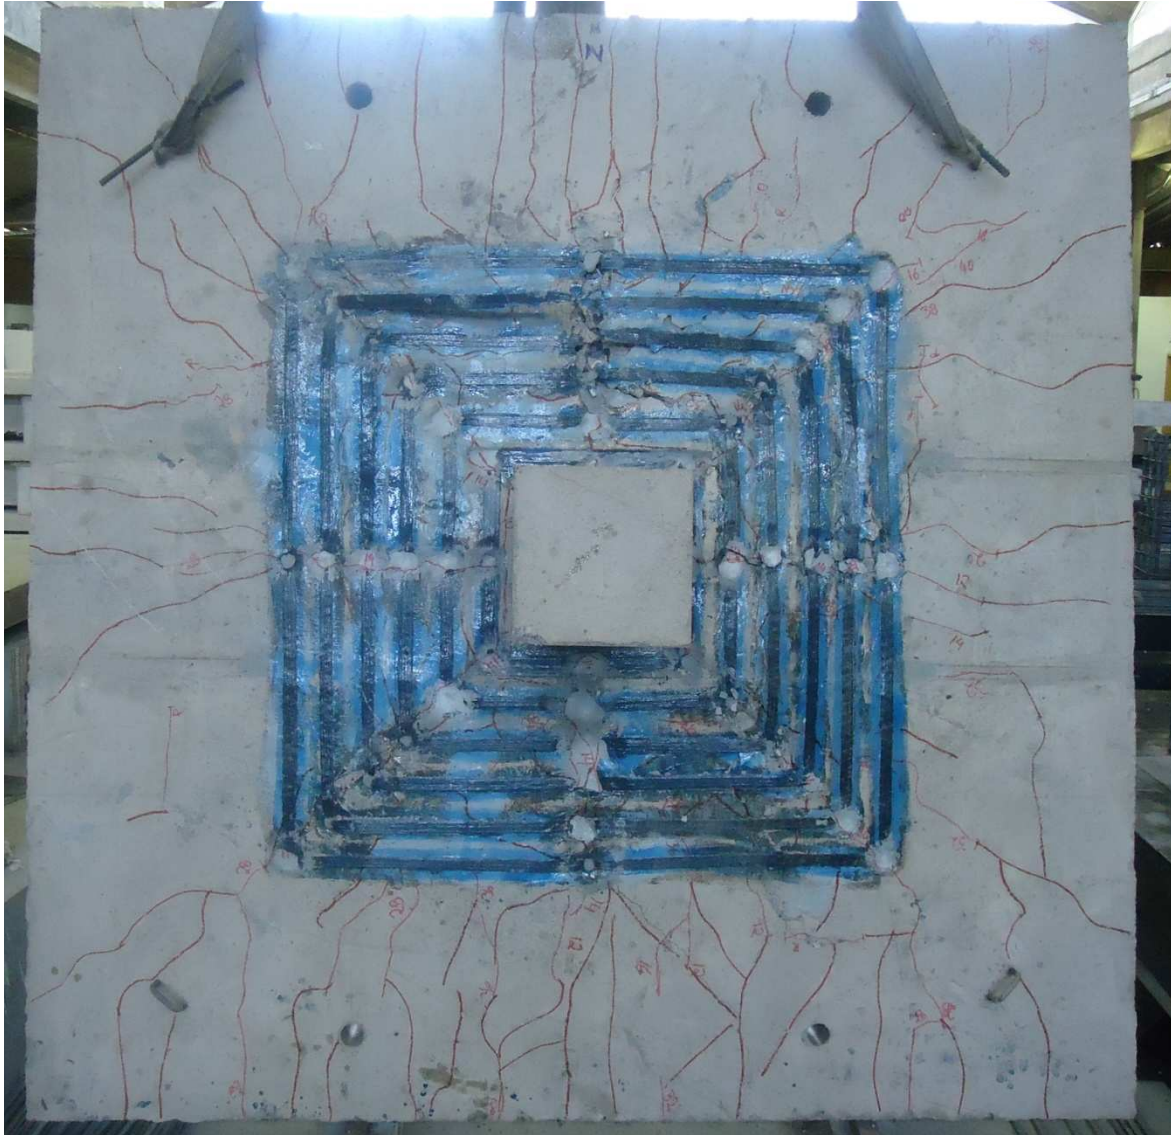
Padrão de fissuração do modelo LR-S
